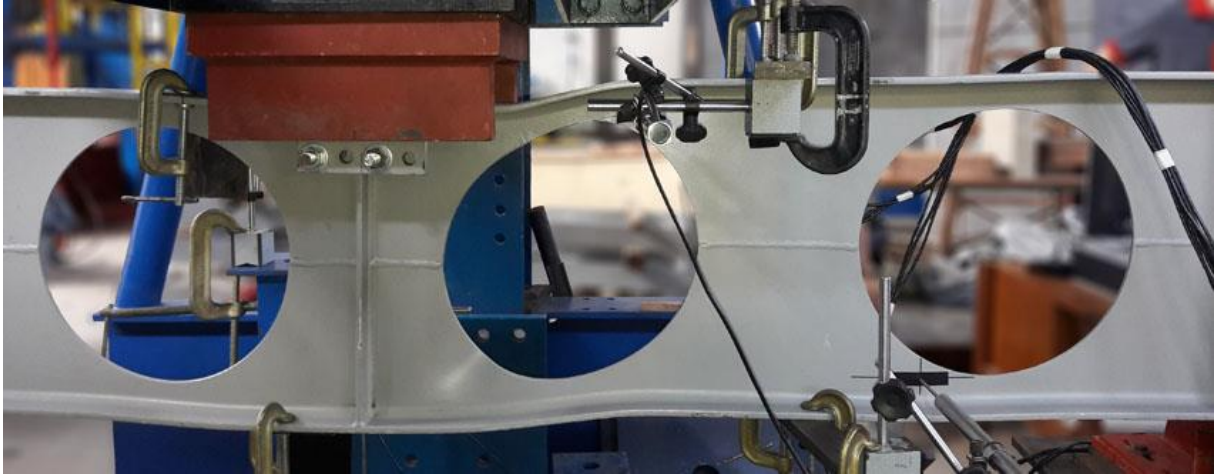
Viga B4 – Falha por mecanismo Vierendeel
